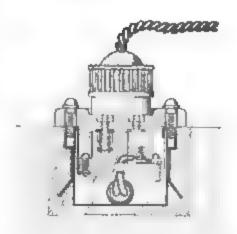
In die Wand eingebauter Dreh-schalter und Stecker bei unter dem Putz verlegter Rohrinstallat on.
